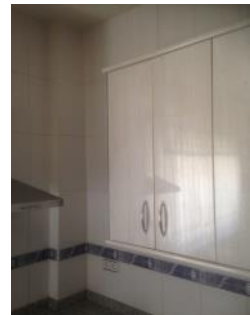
Revestimiento vertical salón comedor planta baja. Año 2015. Fuente propia.
